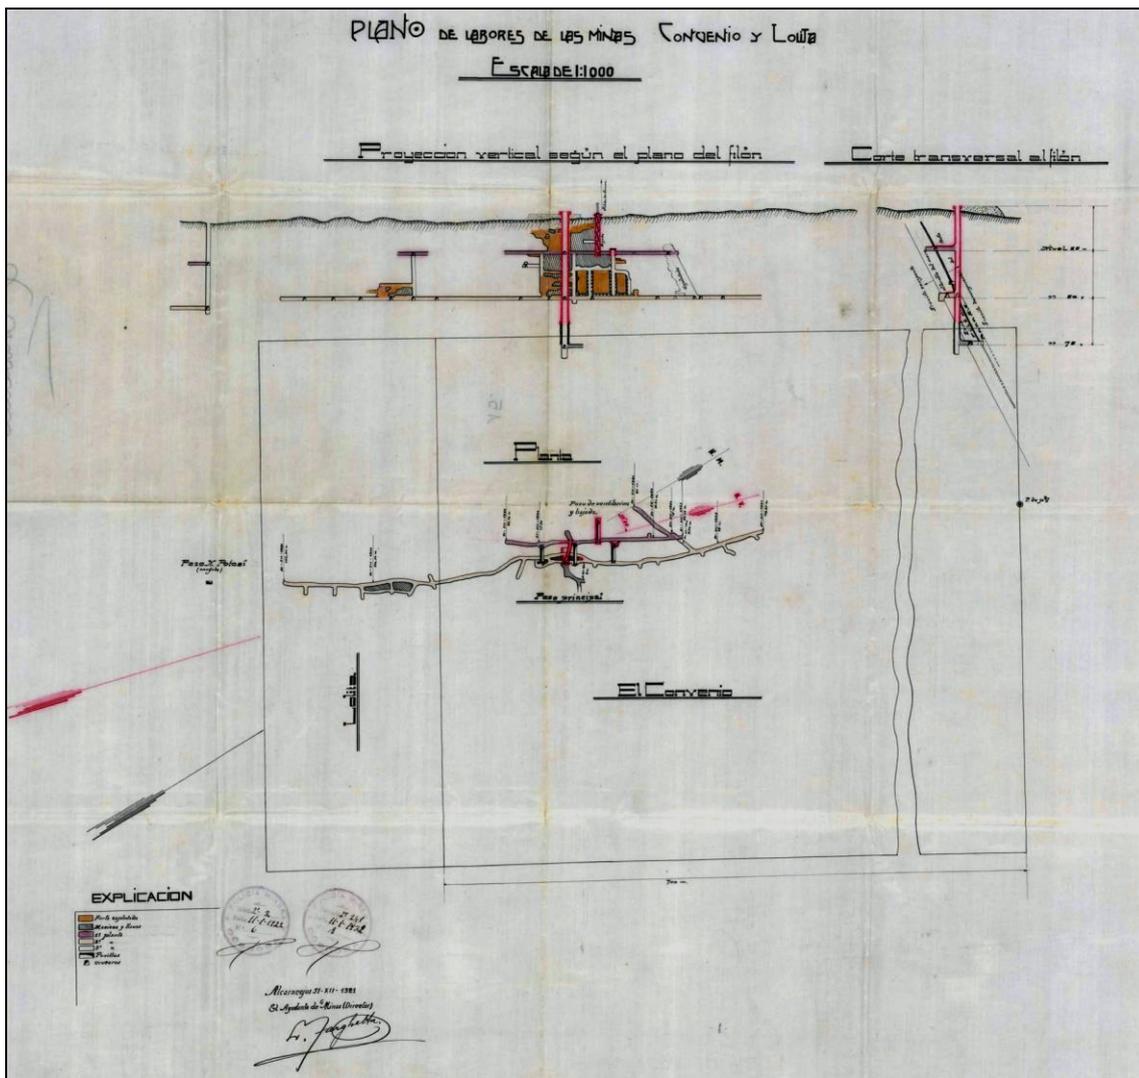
Plano de las minas El Convenio y Lolita (IGME, 1921)
